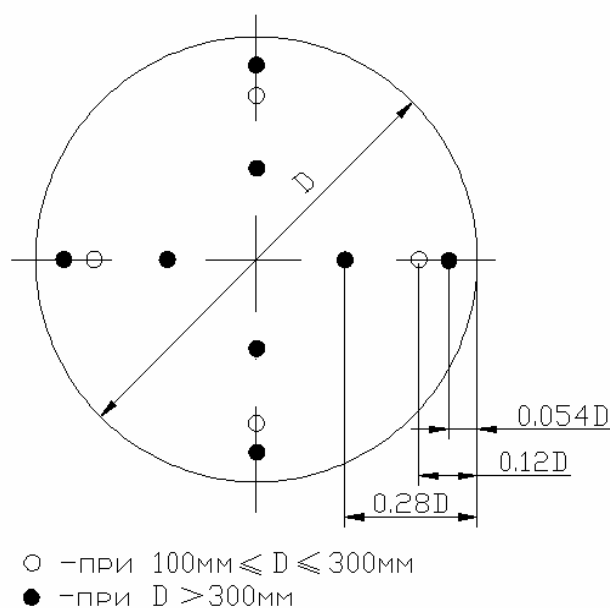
Схема точек замеров для круглого воздухопровода
